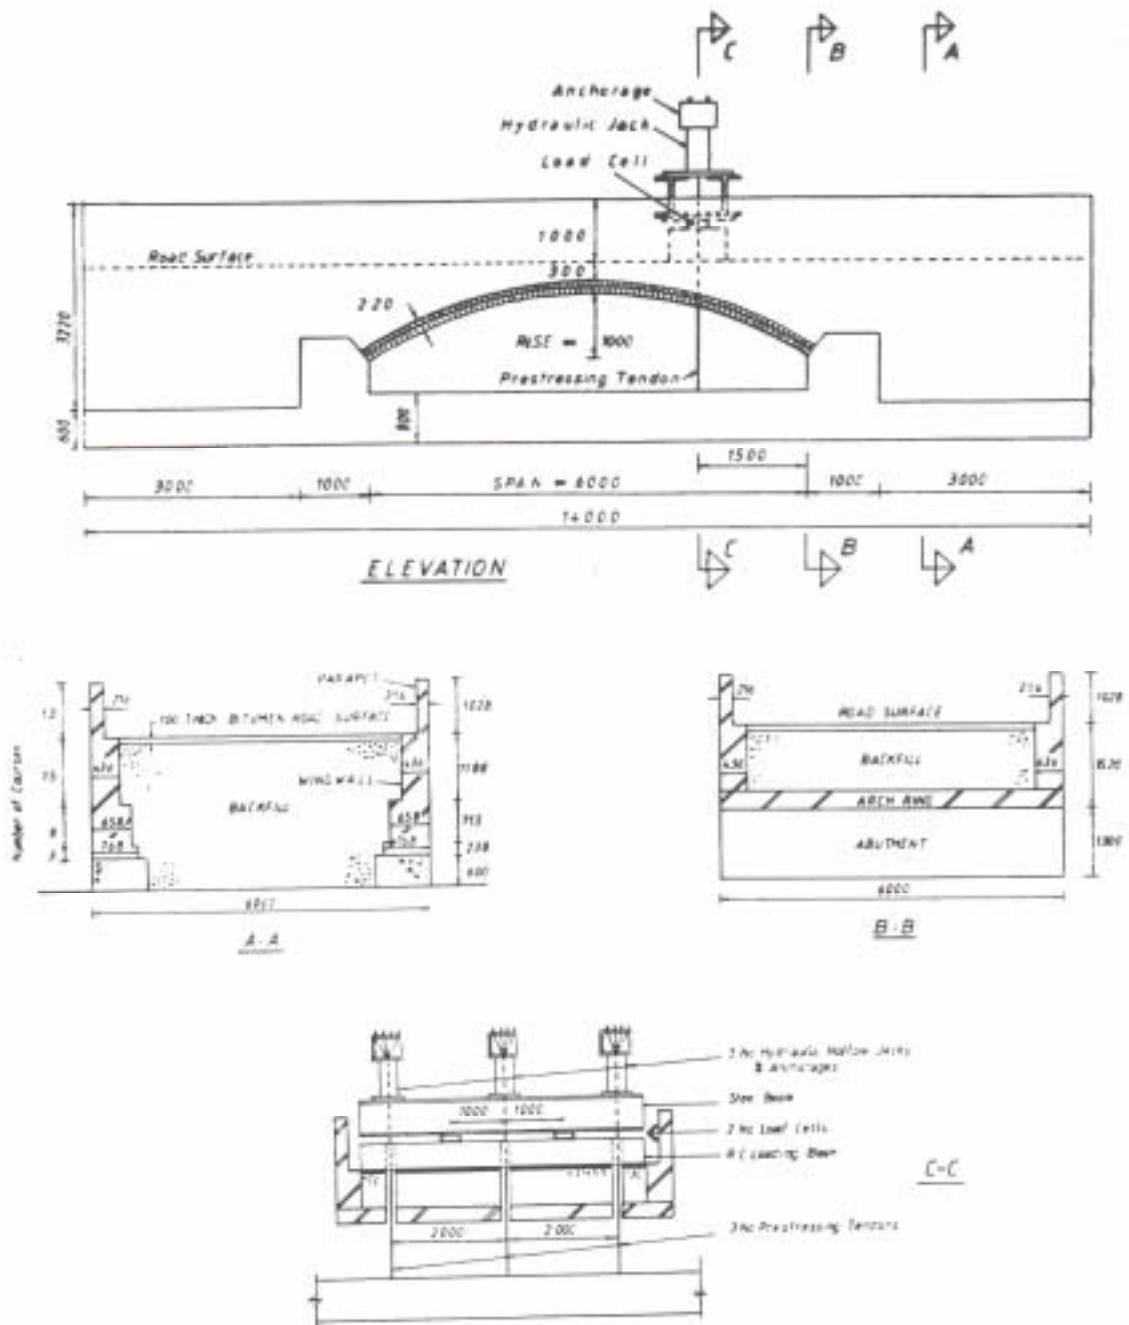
Detalles geométricos, constructivos y de carga del puente rebajado ensayado en el Bolton Institute. Sección longitudinal y secciones transversales [14].
